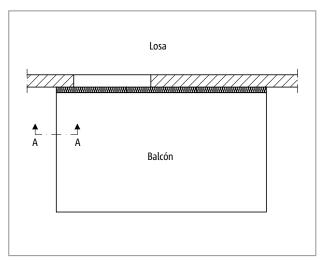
Schöck Isokorb® T tipo K: Ilustración de la posición de sección A-A
